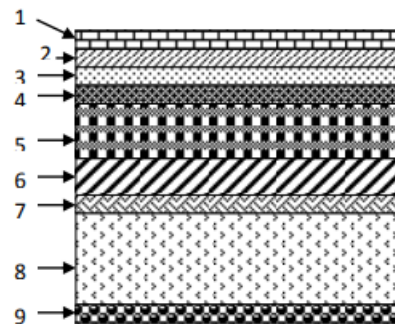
Coupe transversale du plancher terrasse accessible.
